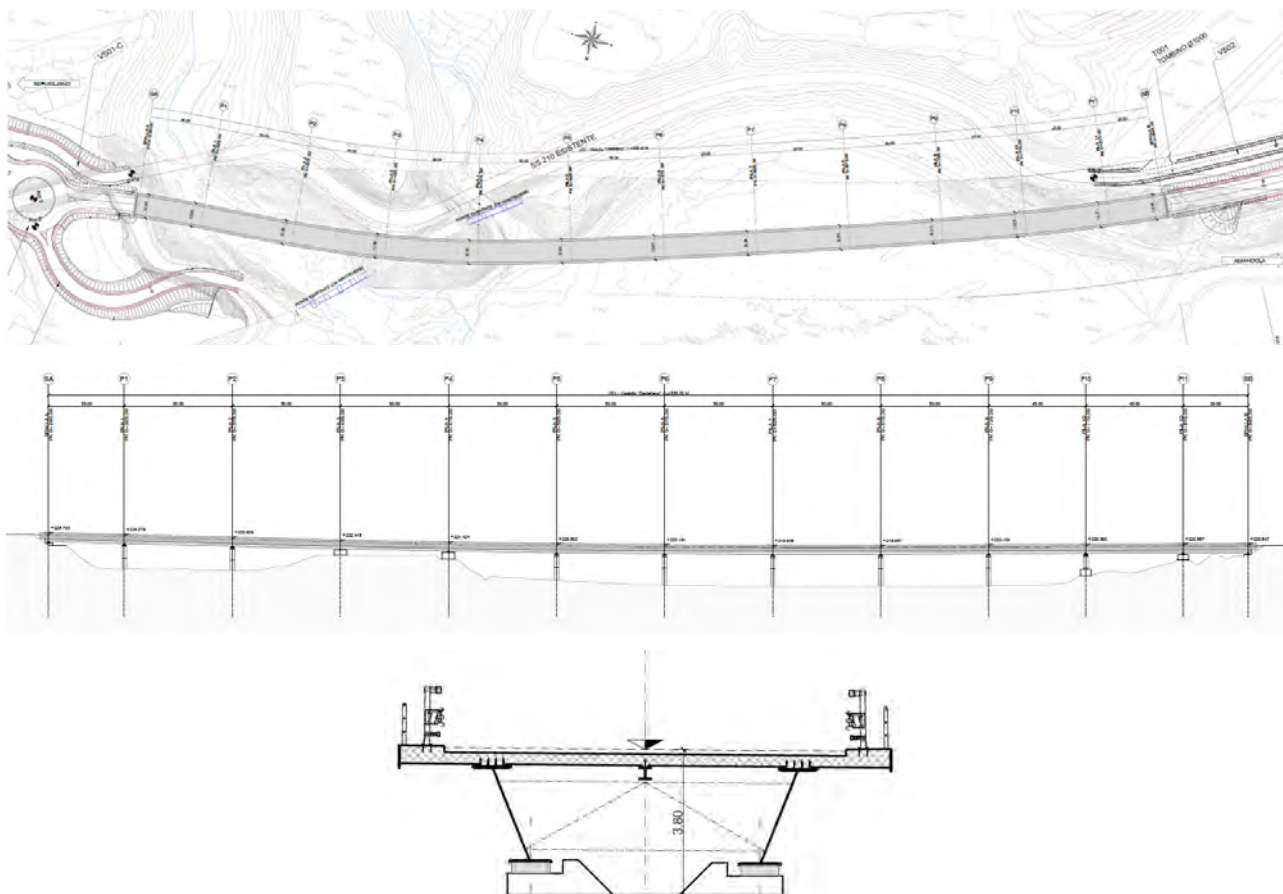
Planimetria, prospetto longitudinale e sezione trasversale dell'opera VI01
